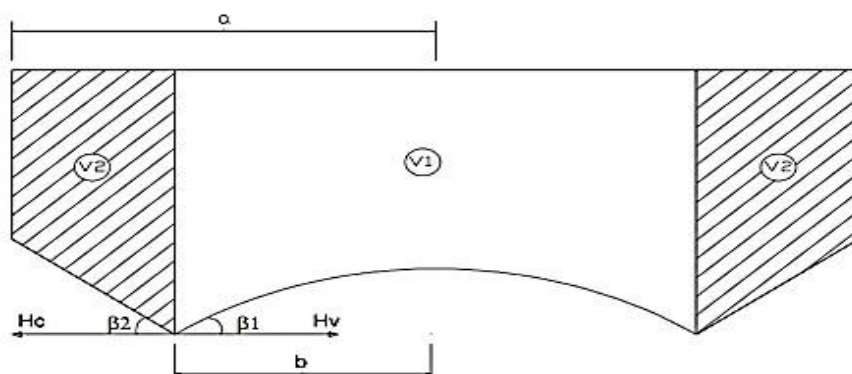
Equilibrio de fuerzas sobre la viga de fondo. (Fuente: Salinas, 1996).
